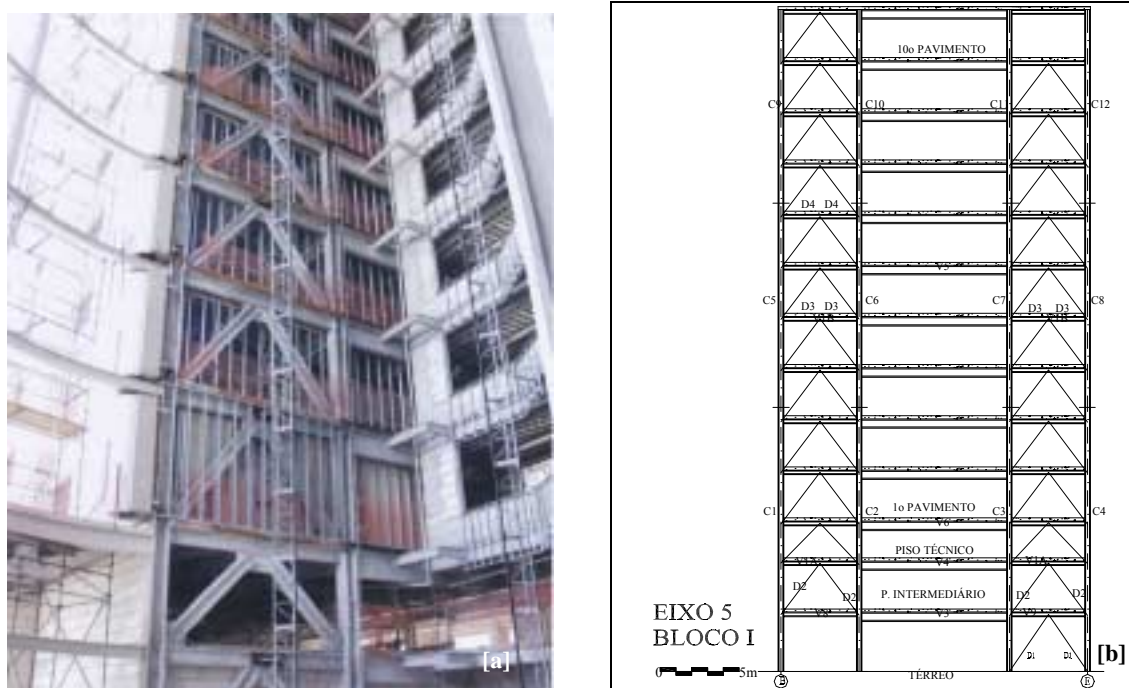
Solução estrutural do edifício E-1: (a) vista dos contraventamentos na região interna do átrio, durante a execução*; (b) esboço da elevação dos contraventamentos.
